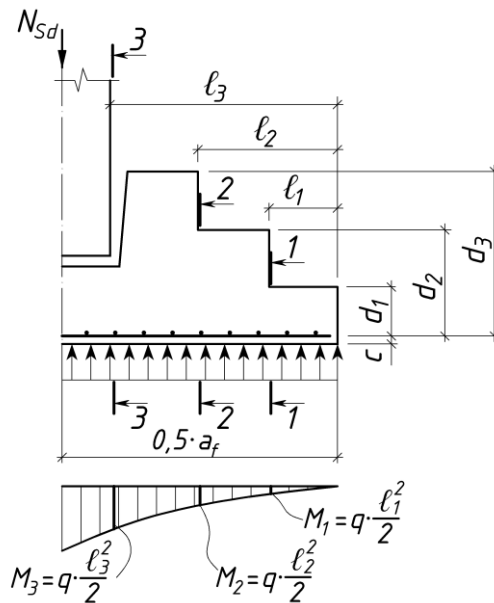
Расчетная схема фундамента при расчете его плитной части
